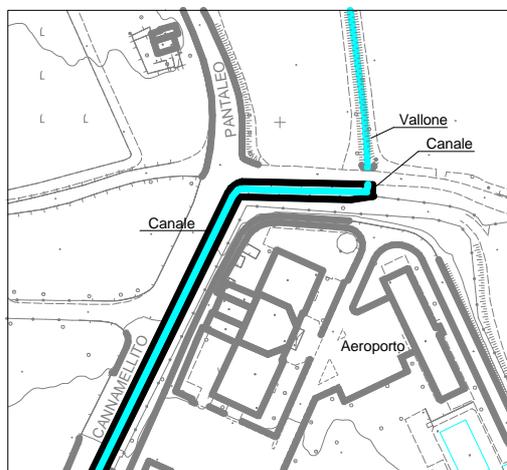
Canalizzazione Cava del Bosco: passaggio dall'alveo al canale
